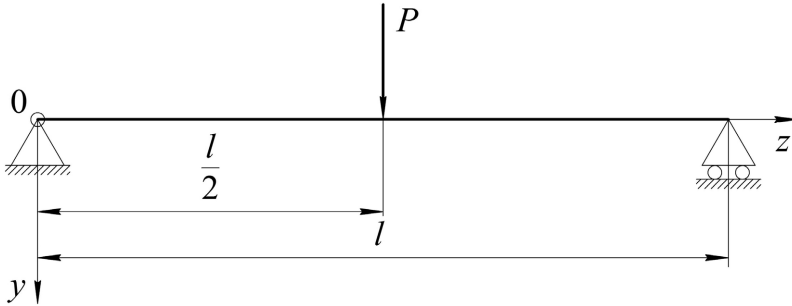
Шарнирно опёртая балка, нагруженная поперечным усилием в срединном сечении
